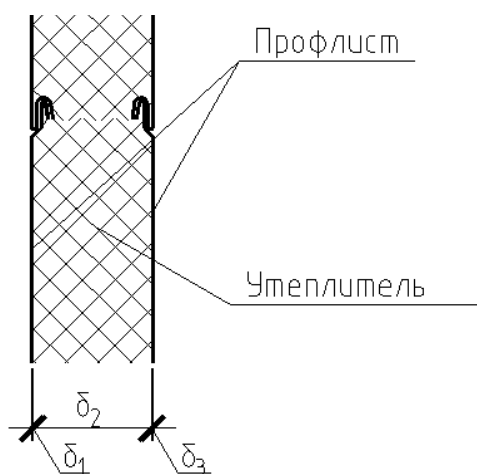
Расчетная схема стеновой ограждающей конструкции
